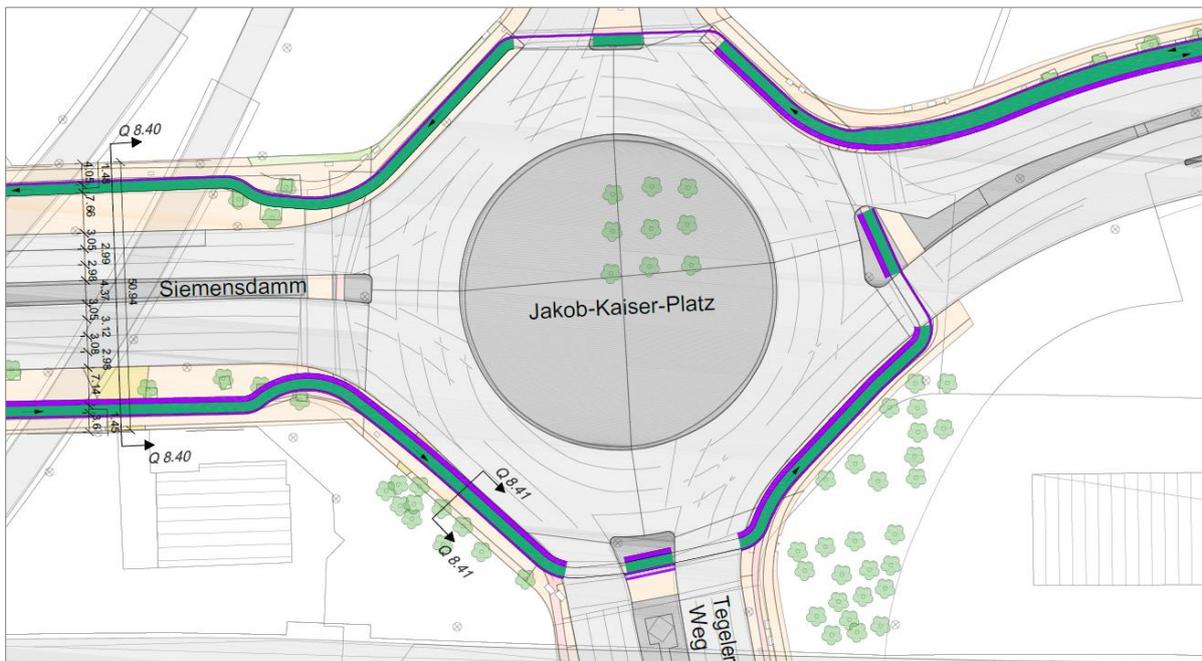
Jakob-Kaiser-Platz – Ausschnitt Lageplan
